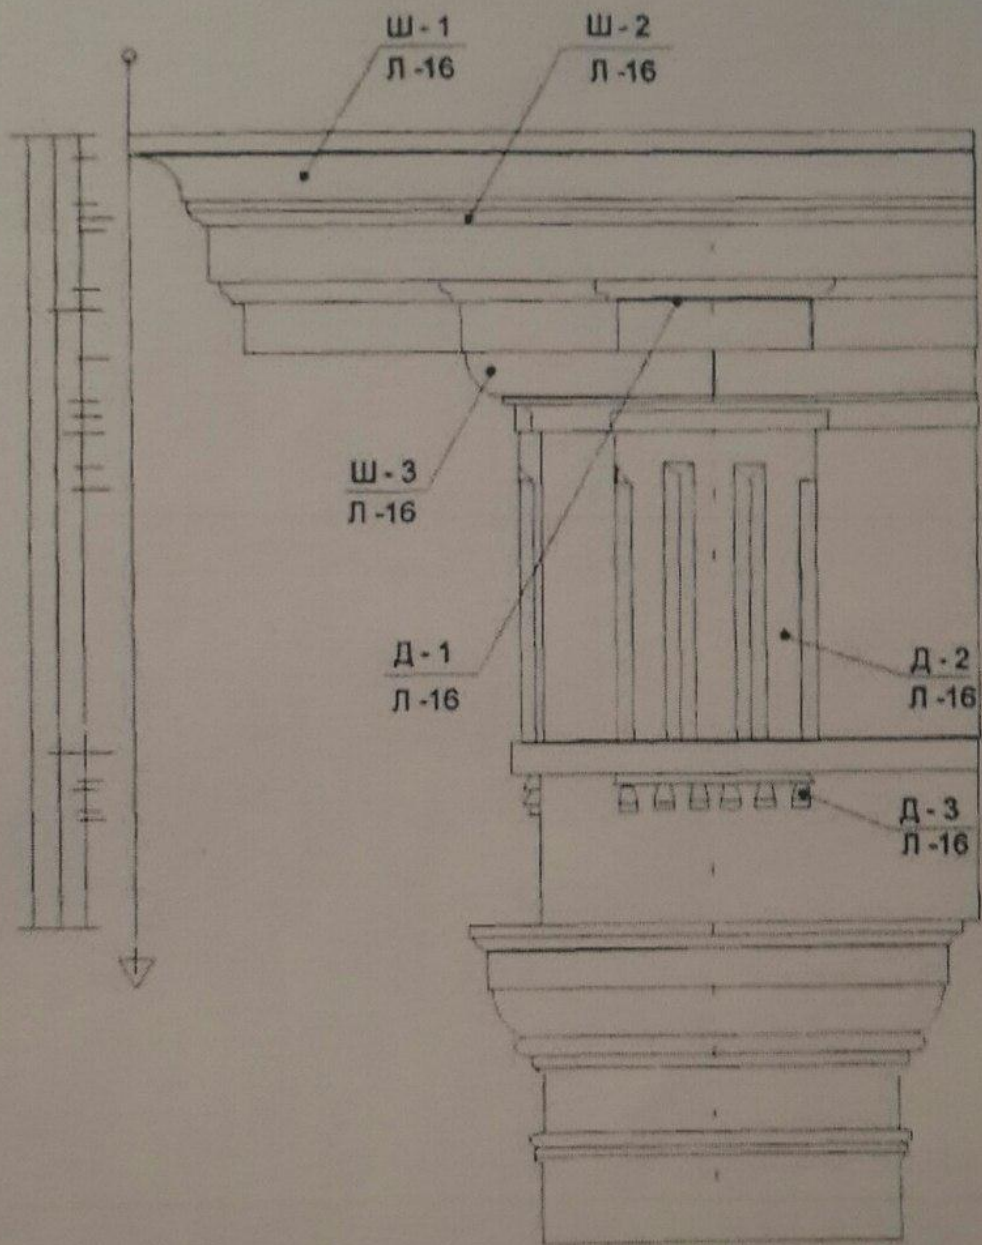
Фрагмент фасада (антаблемент и капитель)
